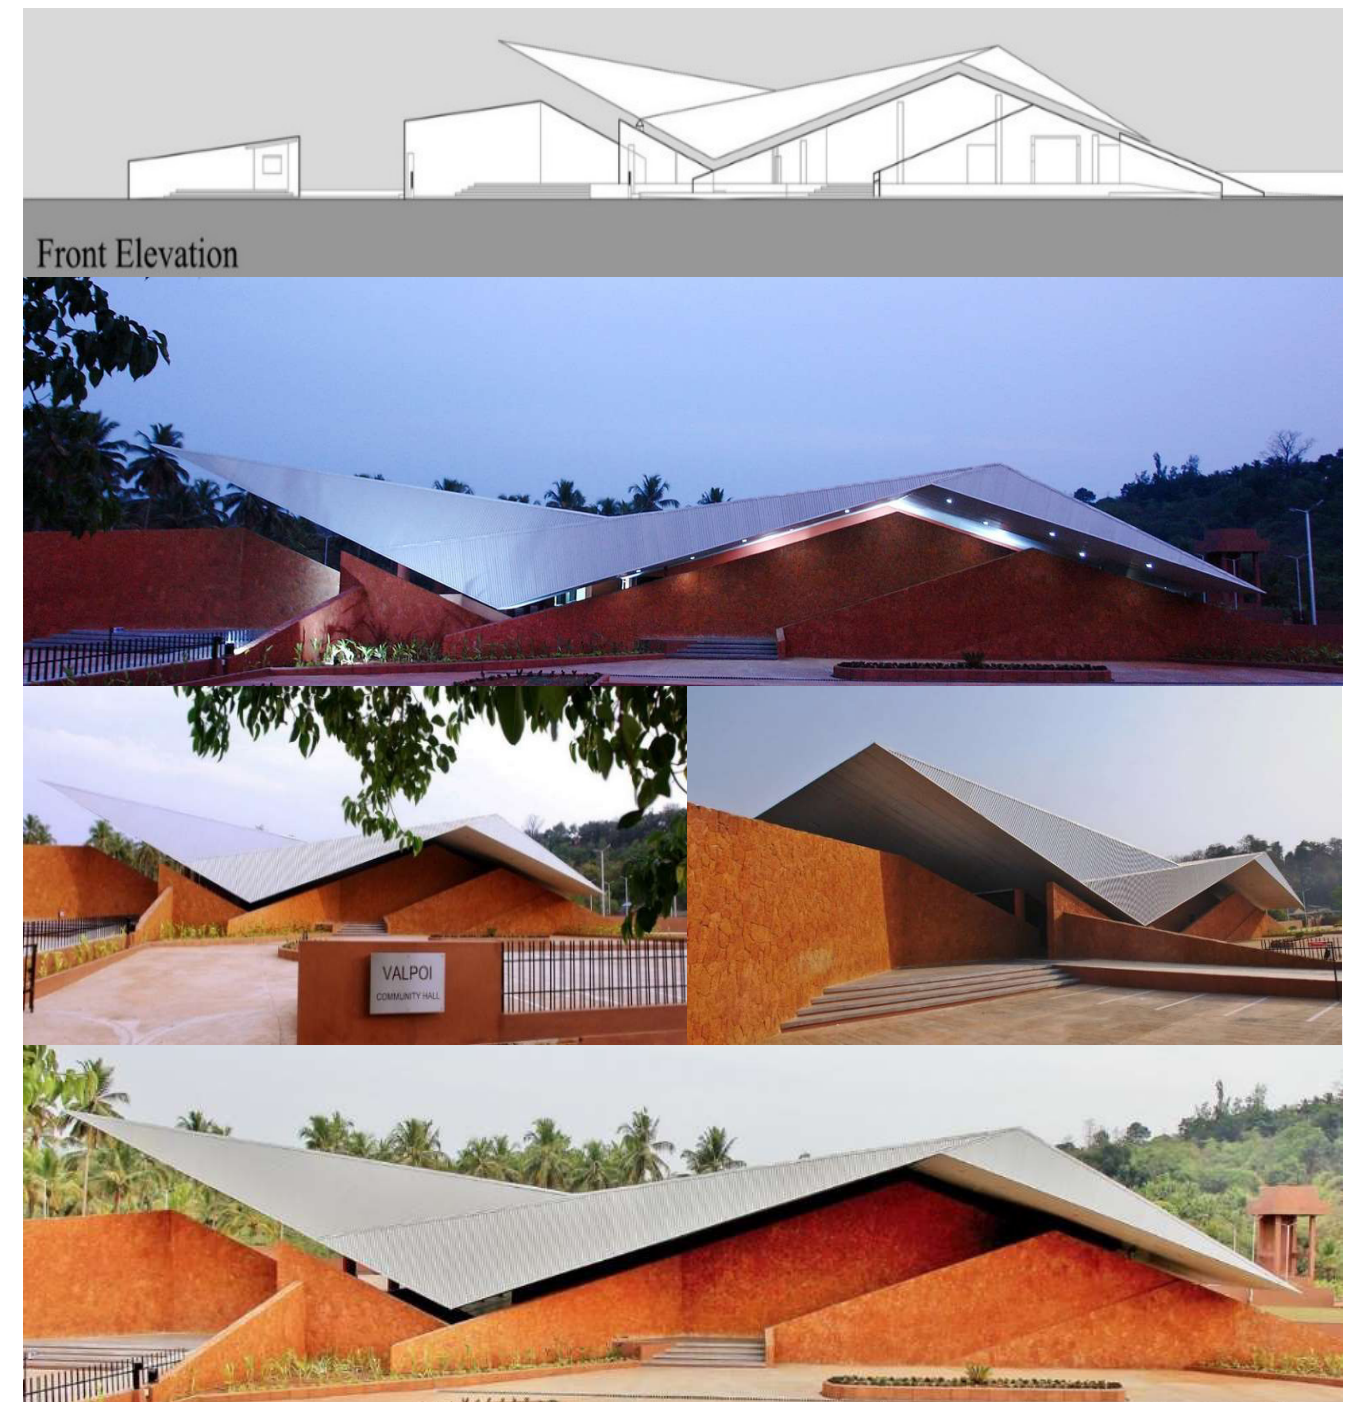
Elevaciones Arquitectónicas Fuente: Plataforma Arquitectura
